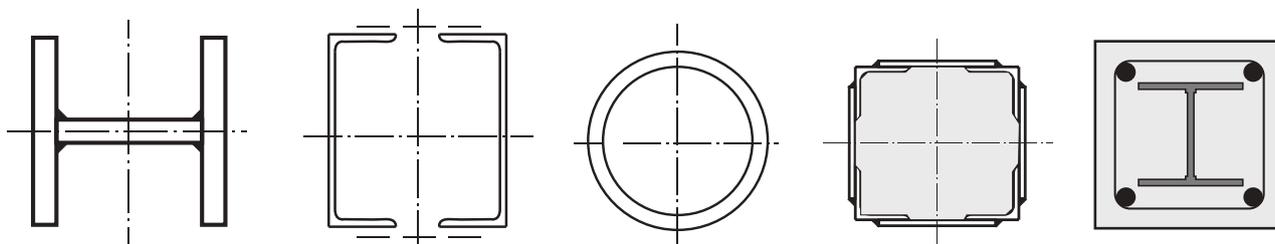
Основные сечения новых колонн при реконструкции: А – сплошные сварные из листов; Б – составленные из прокатных профилей с решеткой или планками; В – замкнутые и трубчатые; Г – сталебетонные составные; Д – сталежелезобетонные
